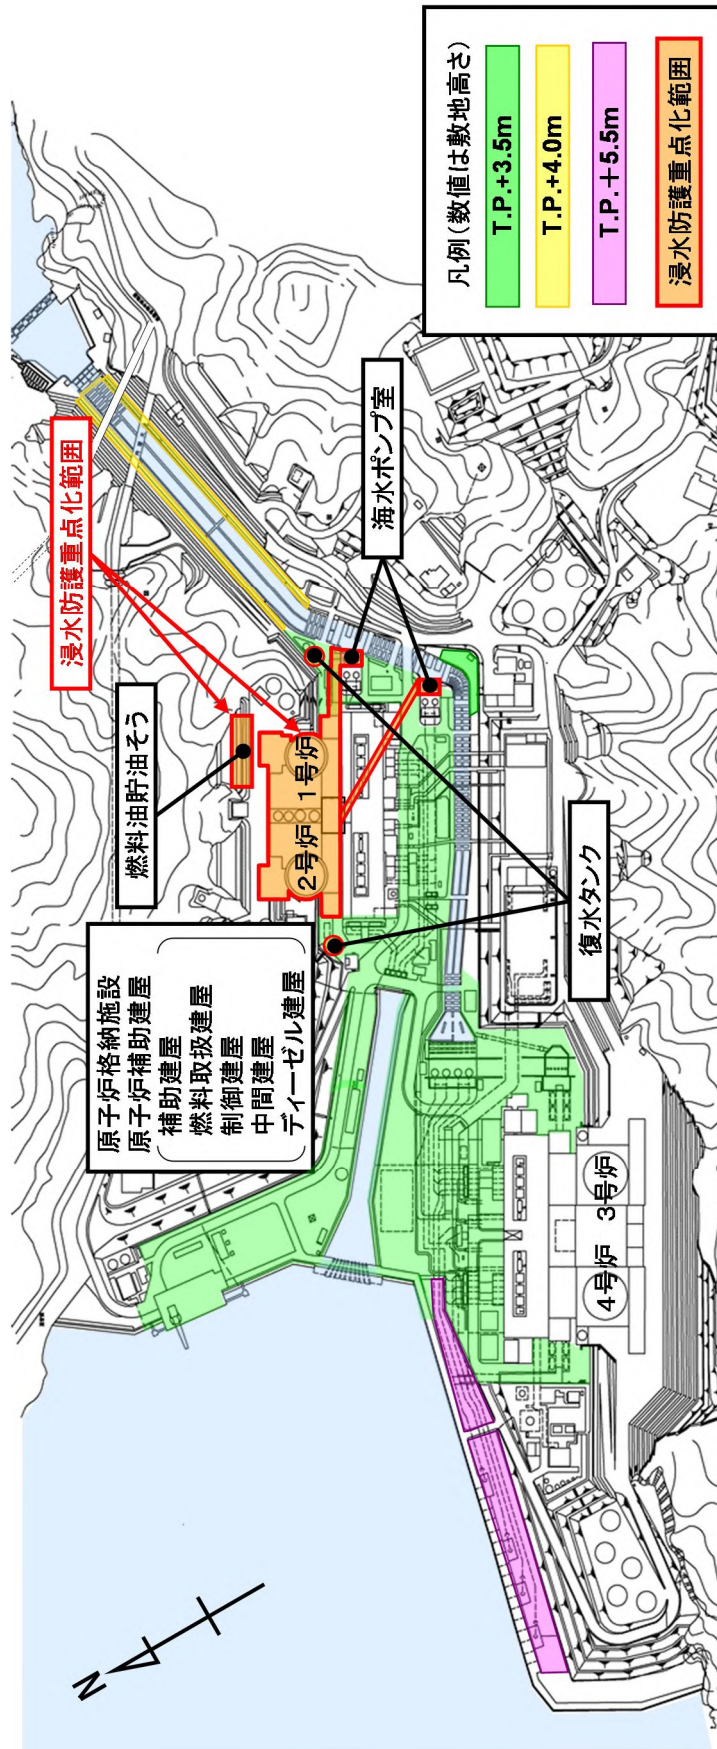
高浜発電所 1号炉及び2号炉 全体配置図
